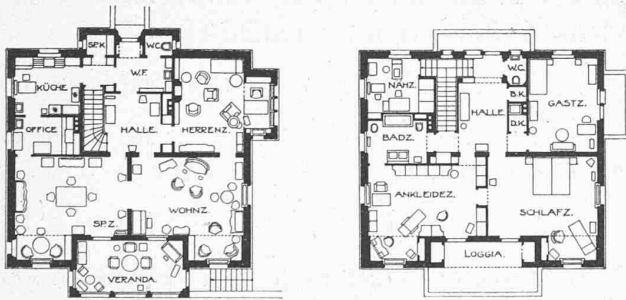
und 3. Grundrisse 1 : 400.
